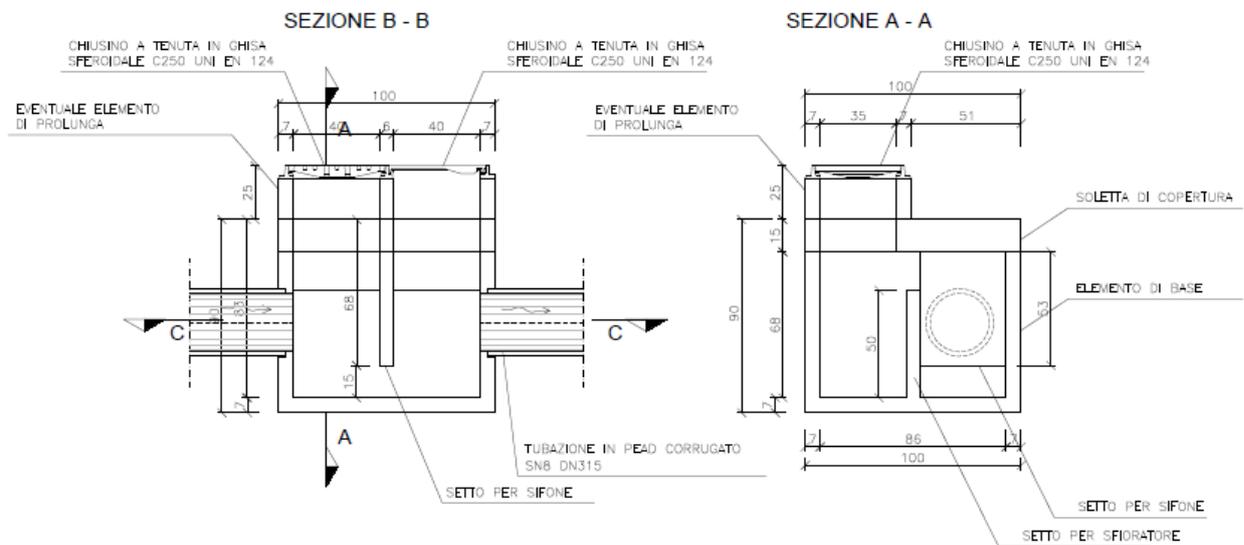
Sezioni tipo pozzetto sifonato.
